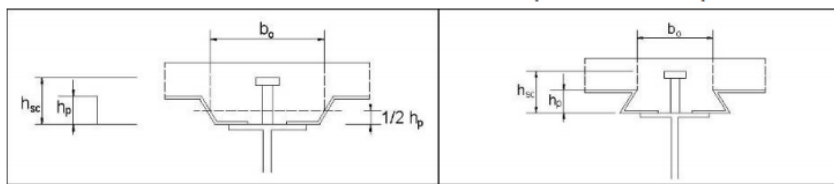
(a) - Disposizione della lamiera grecata rispetto al profilo in acciaio
